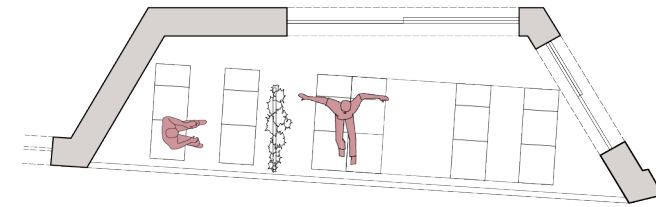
Grundrissvariante 1 - Individuelles Erholen
